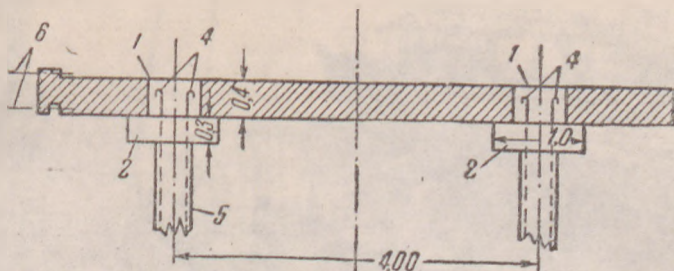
1 — отверстия в звеньях плиты причала; 2 — жел.-бет. площадки на головках свай; 4 — выпуски арматуры жел.-бет. свай; 5 — жел.-бет. сваи; 6 — оси болтов для крепления отбойной рамы
